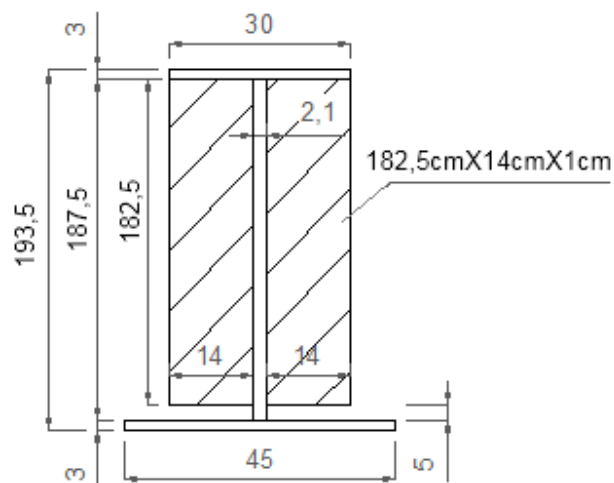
Rigidizadores transversales de intermedios (Sección D y J)
